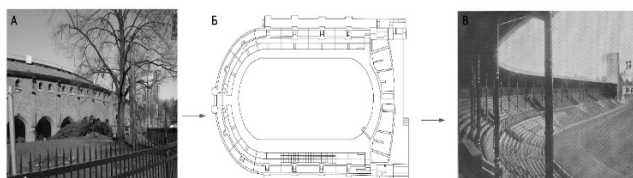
Стокгольмский стадион (1912г.) а) наружный фасад б) план в) вид с трибун
